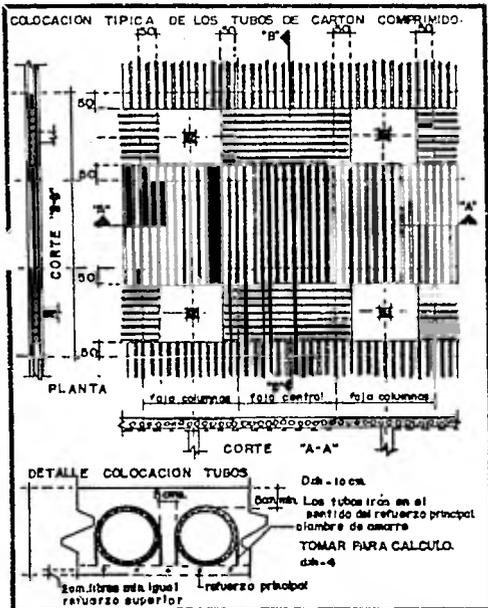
Entrepiso tipo placas planas, con tubos de cartón comprimido.
